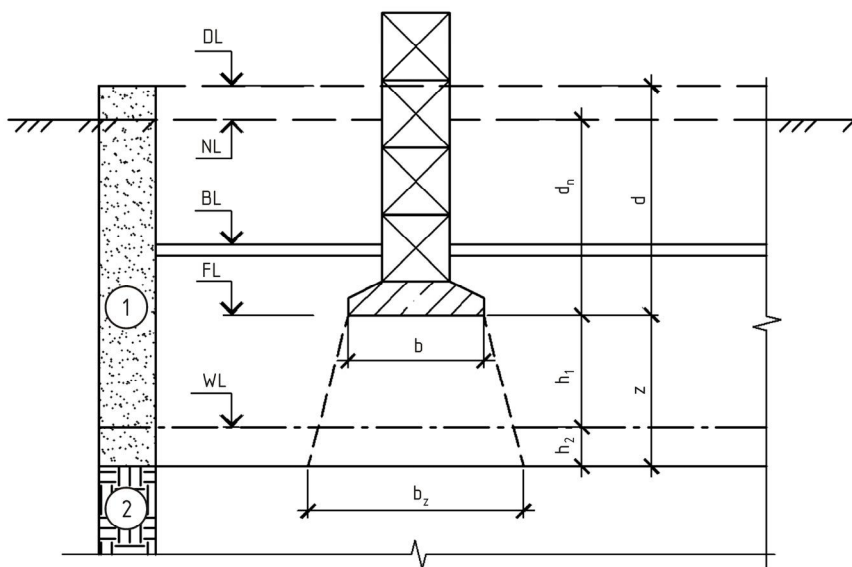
Расчетная схема для проверки расчетного сопротивления по подстилающему слою грунта: 1 – грунт верхнего слоя; 2 – грунт подстилающего слоя
